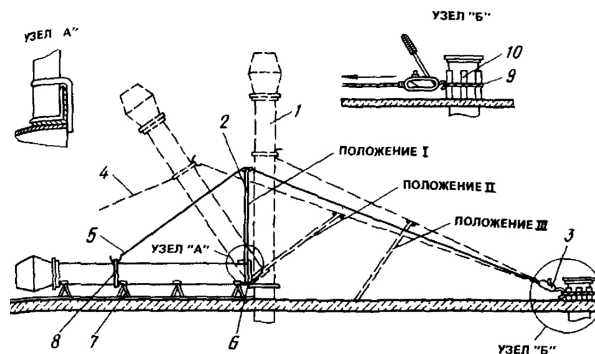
Схема организации монтажной зоны при монтаже вертикальных воздухопроводов на кровле здания с помощью падающей мачты: 1 - воздухопровод; 2 - мачта; 3 - монтажно-тяговый механизм; 4 - растяжка; 5 - тяга; 6 - шарнир; 7 - подставка; 8 - хомут; 9 - инвентарный строп; 10 - подкладки
